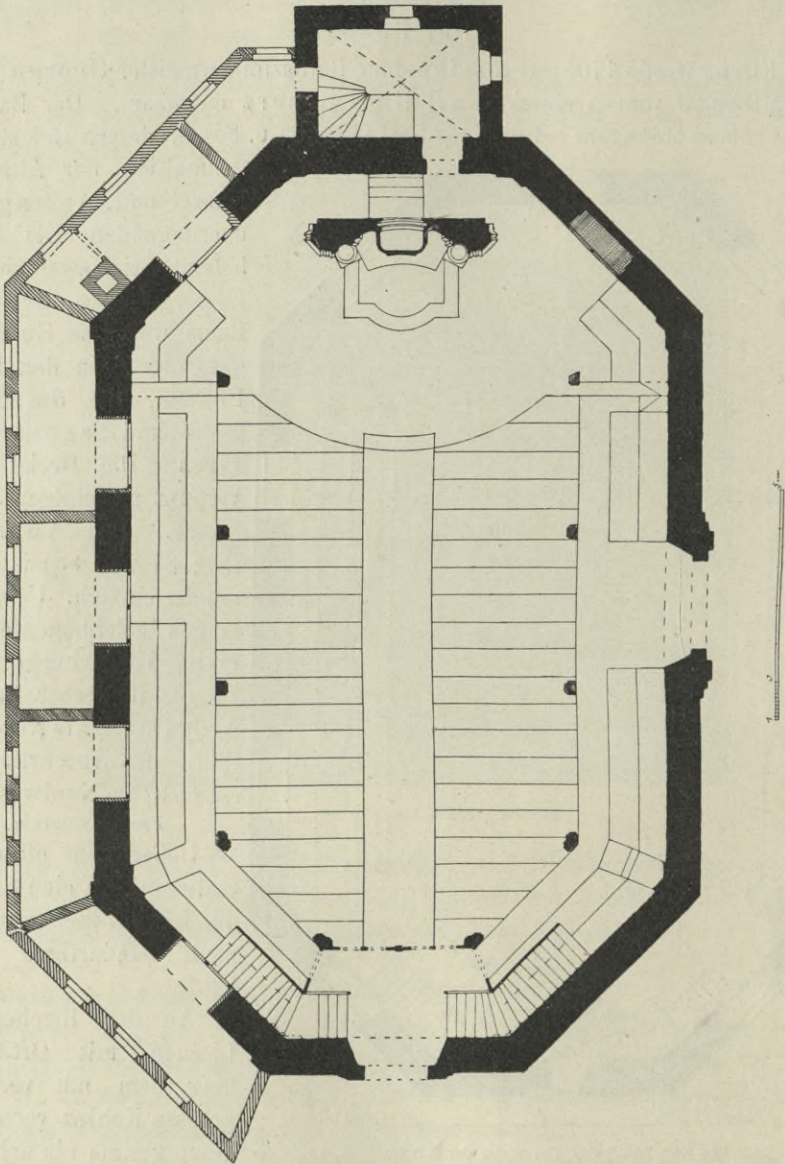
Loschwitz, Grundriss der Kirche, Erdgeschoss. Zustand von 1898.
